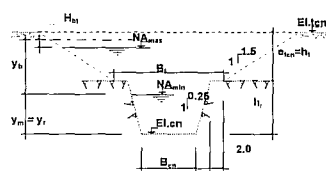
Seção transversal típica de canal de adução em rocha.
